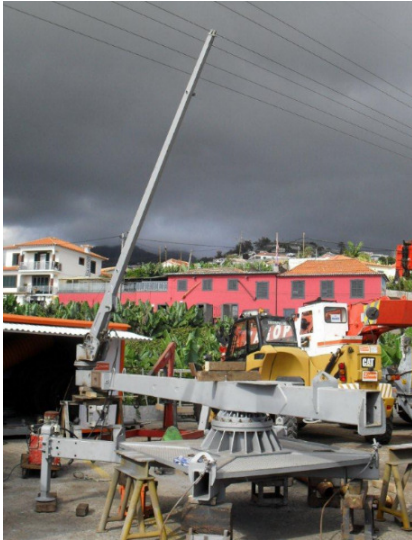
, 4.10 – Equipamento auxiliar para a betonagem dos tetrápodes
